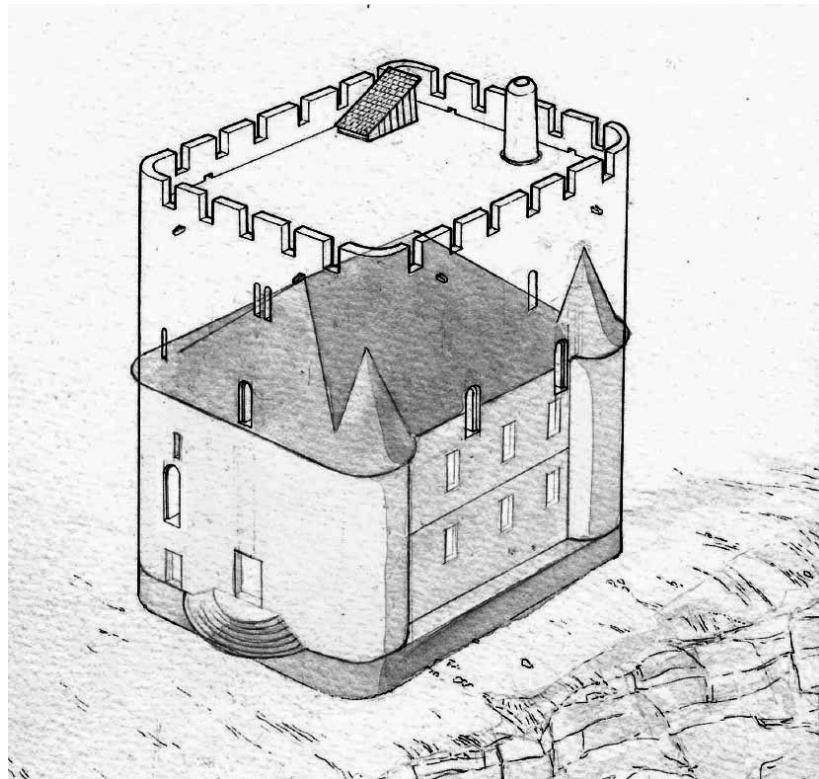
essai de restitution du château lors de sa construction (dessin L. Duigou).
